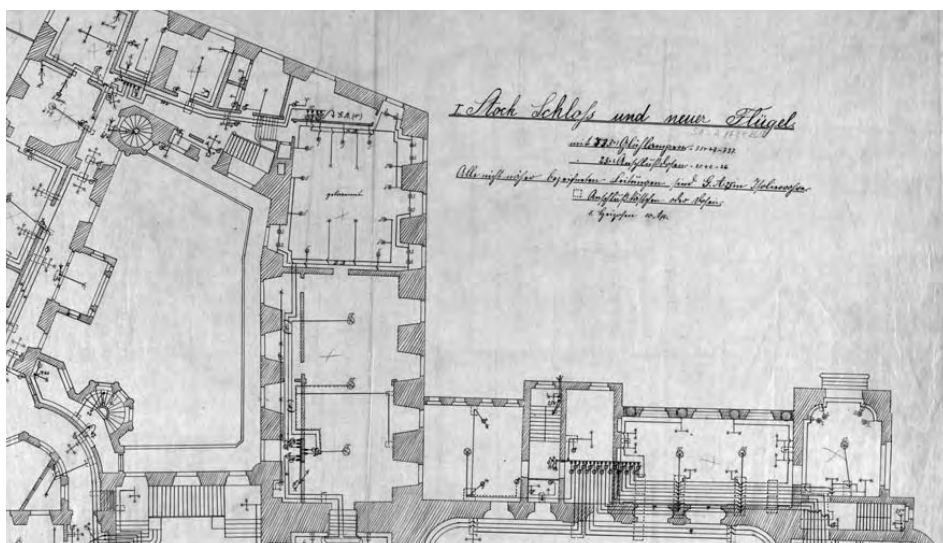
Elektroinstallationen im Schloss Bückeburg, Grundriss des ersten Obergeschosses (NLA – StA Bückeburg S 1 A Nr. 1784 Bl. 5).
